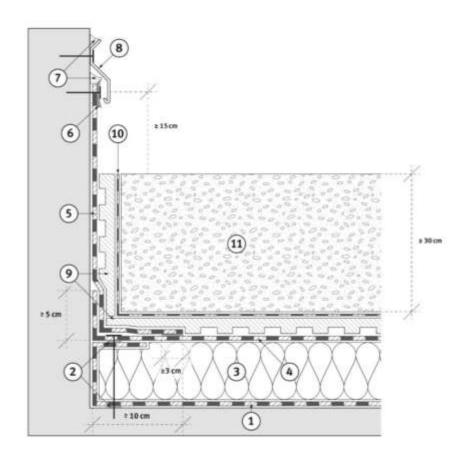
Relevé d'étanchéité et zone stérile en toiture-terrasse Jardin sur support en maçonnerie.
